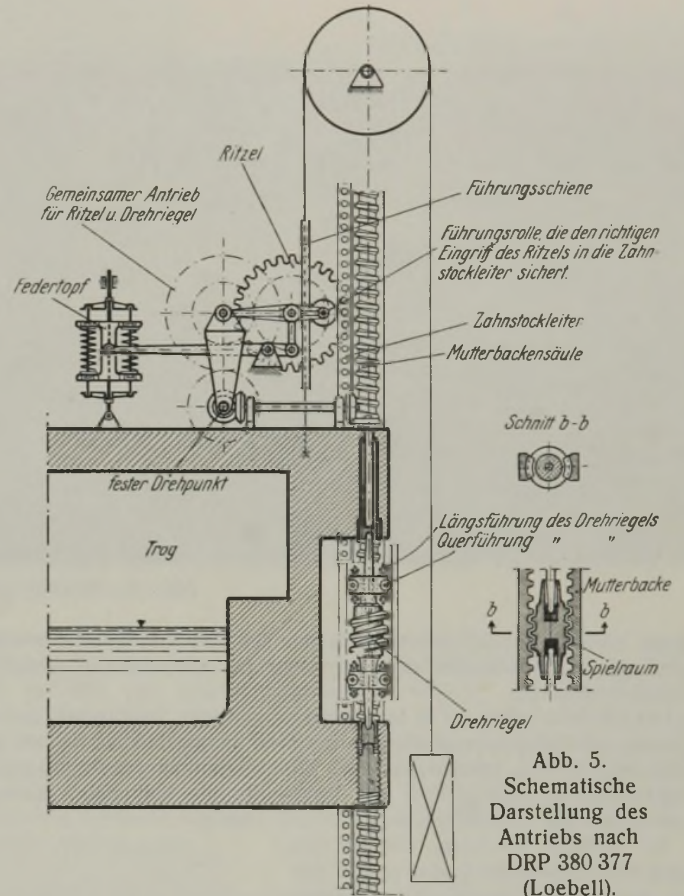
Schematische Darstellung des Antriebs nach DRP 380 377 (Loebell).
